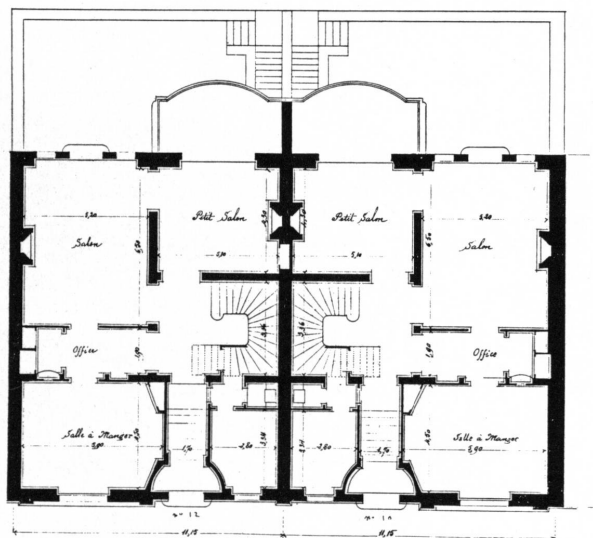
Rue Bellot nos 10 et 12. Plan du rez-de-chaussée.
